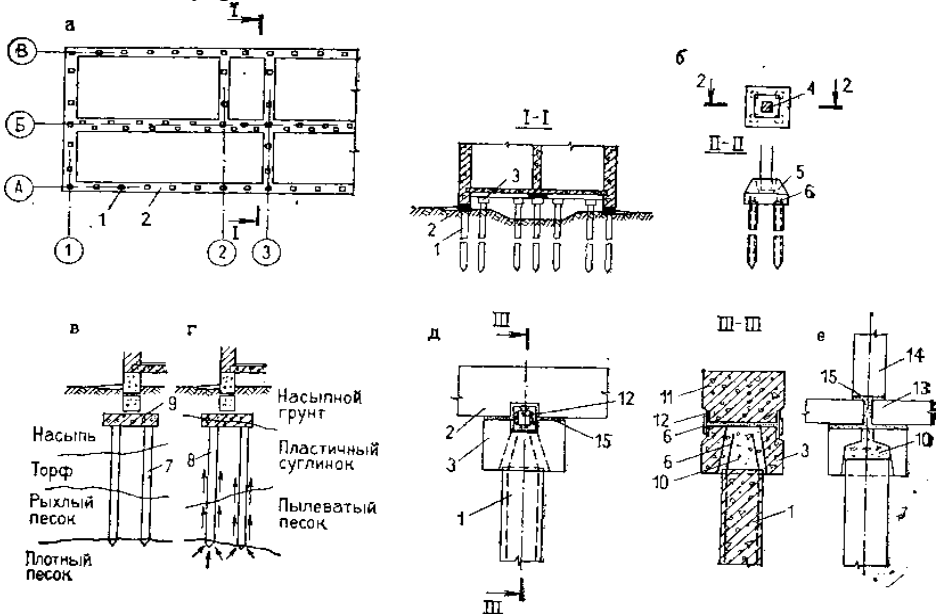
Пальві фундаменти: а - фрагмент плану пальвих фундаментів; б - фундамент під колону; в - фундамент на палях-стійках; г - фундамент наисячих палях; е - деталь пальового фундаменту без ростверку: 1 - паля; 2 - ростверк; 3 - оголовок палі; 4 - колона; 5 - монолітний росверк стаканного типу під колону; 6 - армування палі; 7 - паля-стійка; 8 -исяча
